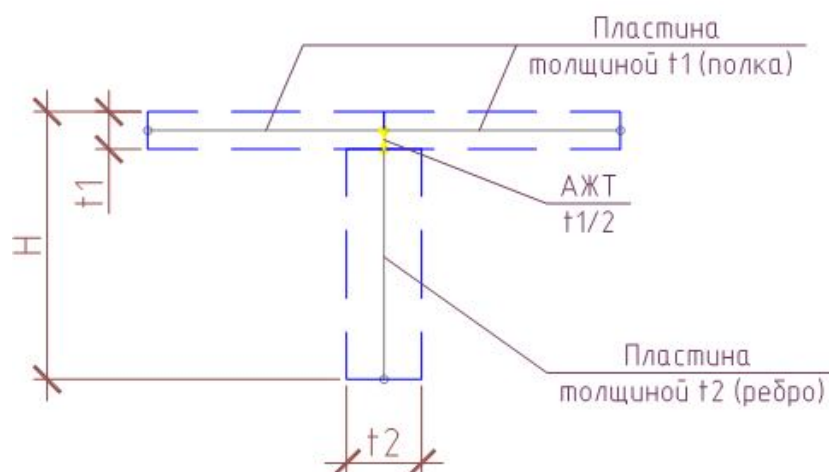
Моделирование перекрытия оболочечными элементами и стержнями в виде тавра.
